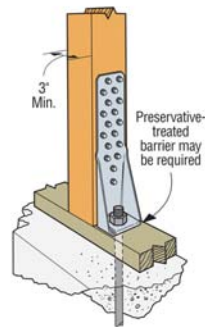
Anclajes de soleras al Hormigón Armado por medio de varillas roscadas empotradas en la platea
